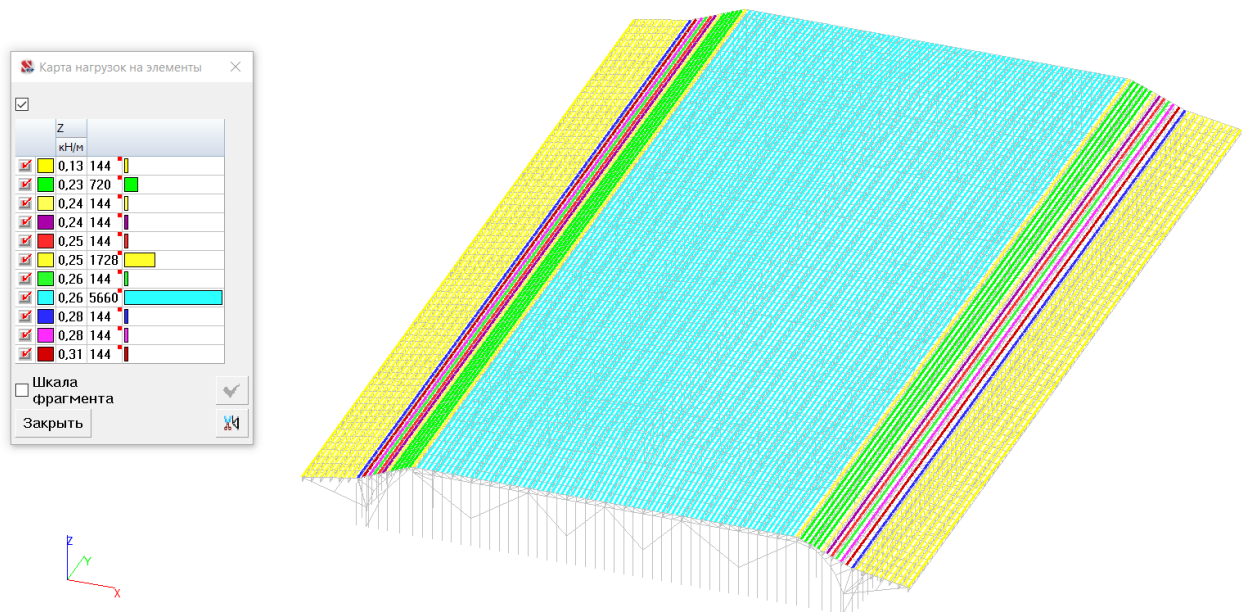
Карта нагрузок на элементы от веса кровли для варианта каркаса с консолями
